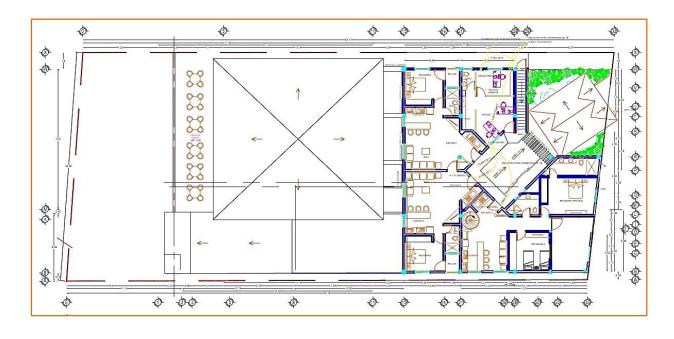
Plano arquitectónico del Primer nivel del proyecto.
